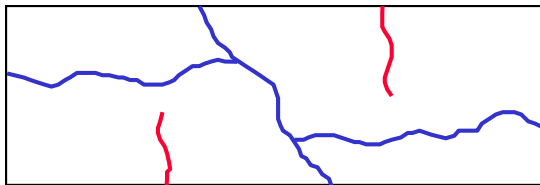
Ejemplo de Medición de Grietas Pavimento de Hormigón
